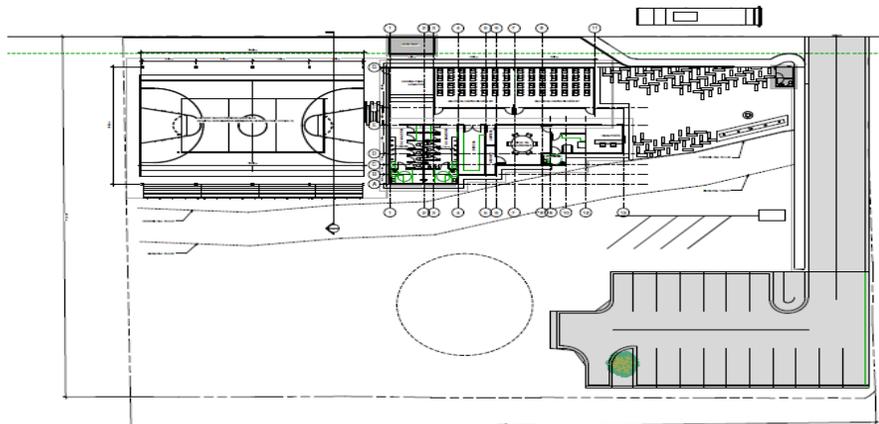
Detalle general de la planta arquitectónica del proyecto.
